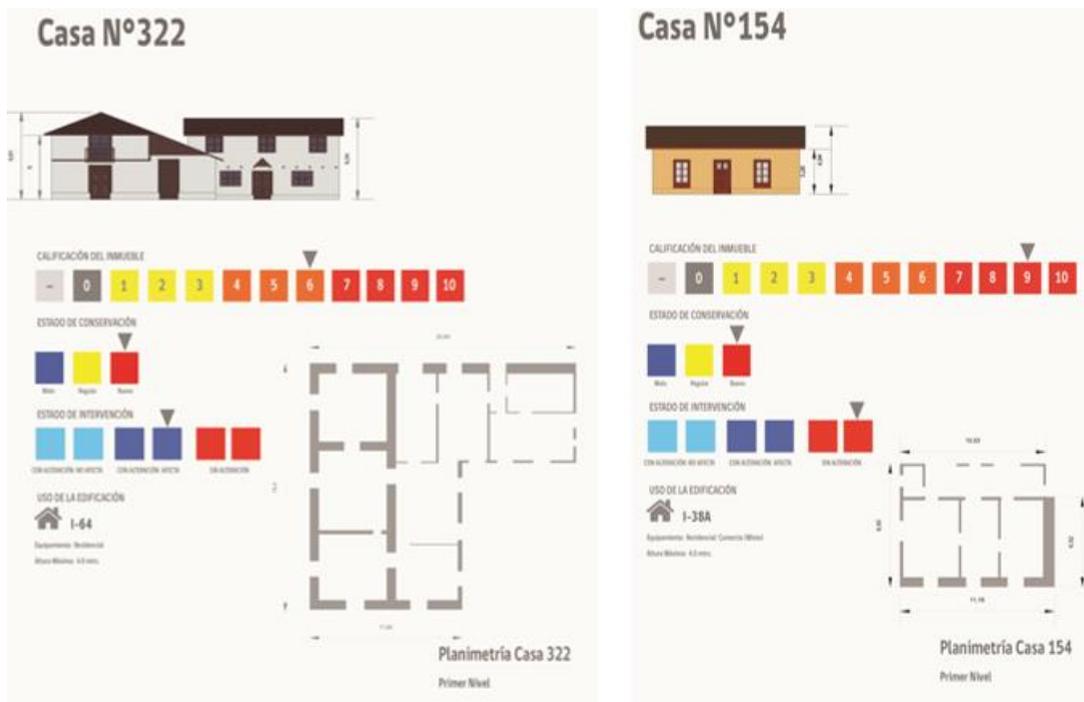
Plantas y elevaciones inmuebles ZT Pueblo de Zúñiga, OTR OH CMN, 2024.
